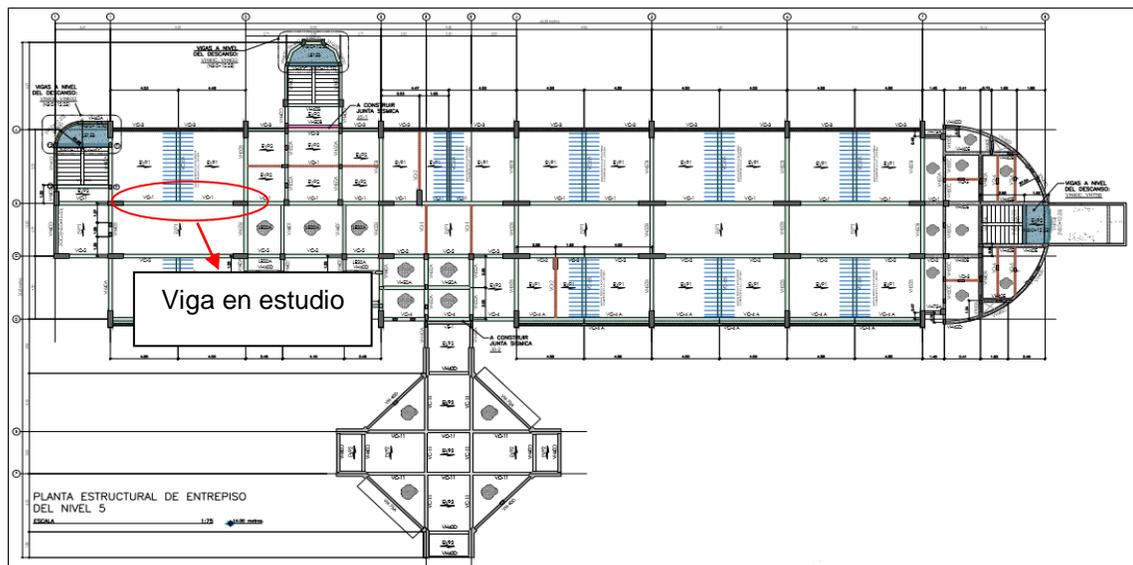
Viga tipo VC-1 en estudio del edificio TIC'S.
